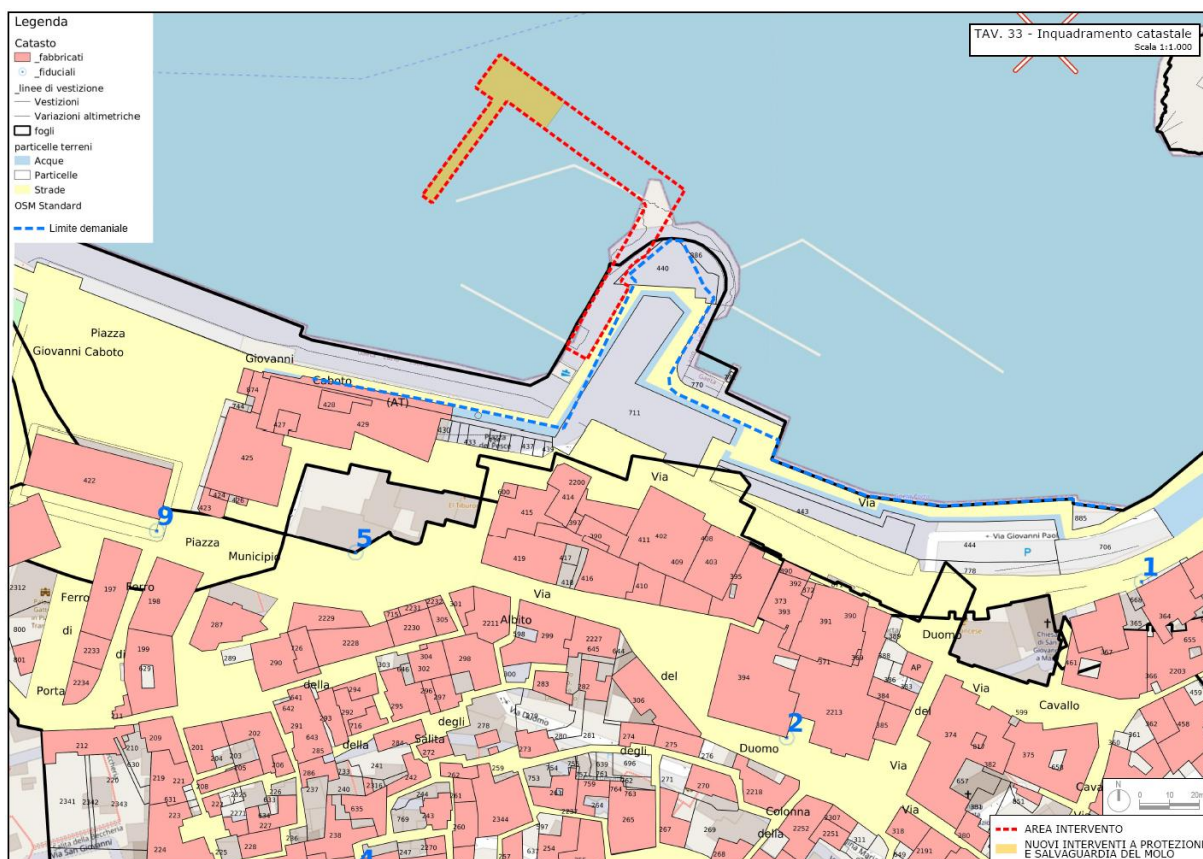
Planimetria catastale con individuazione dell'area di intervento
